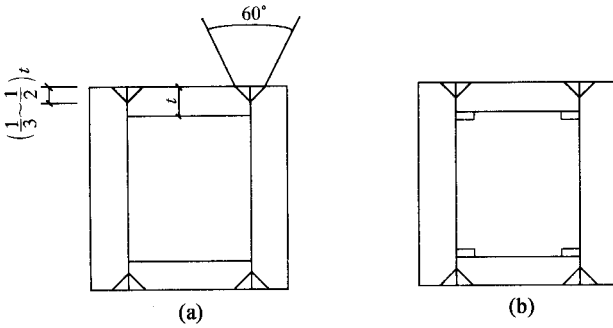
箱形组合柱的角部组装焊缝
